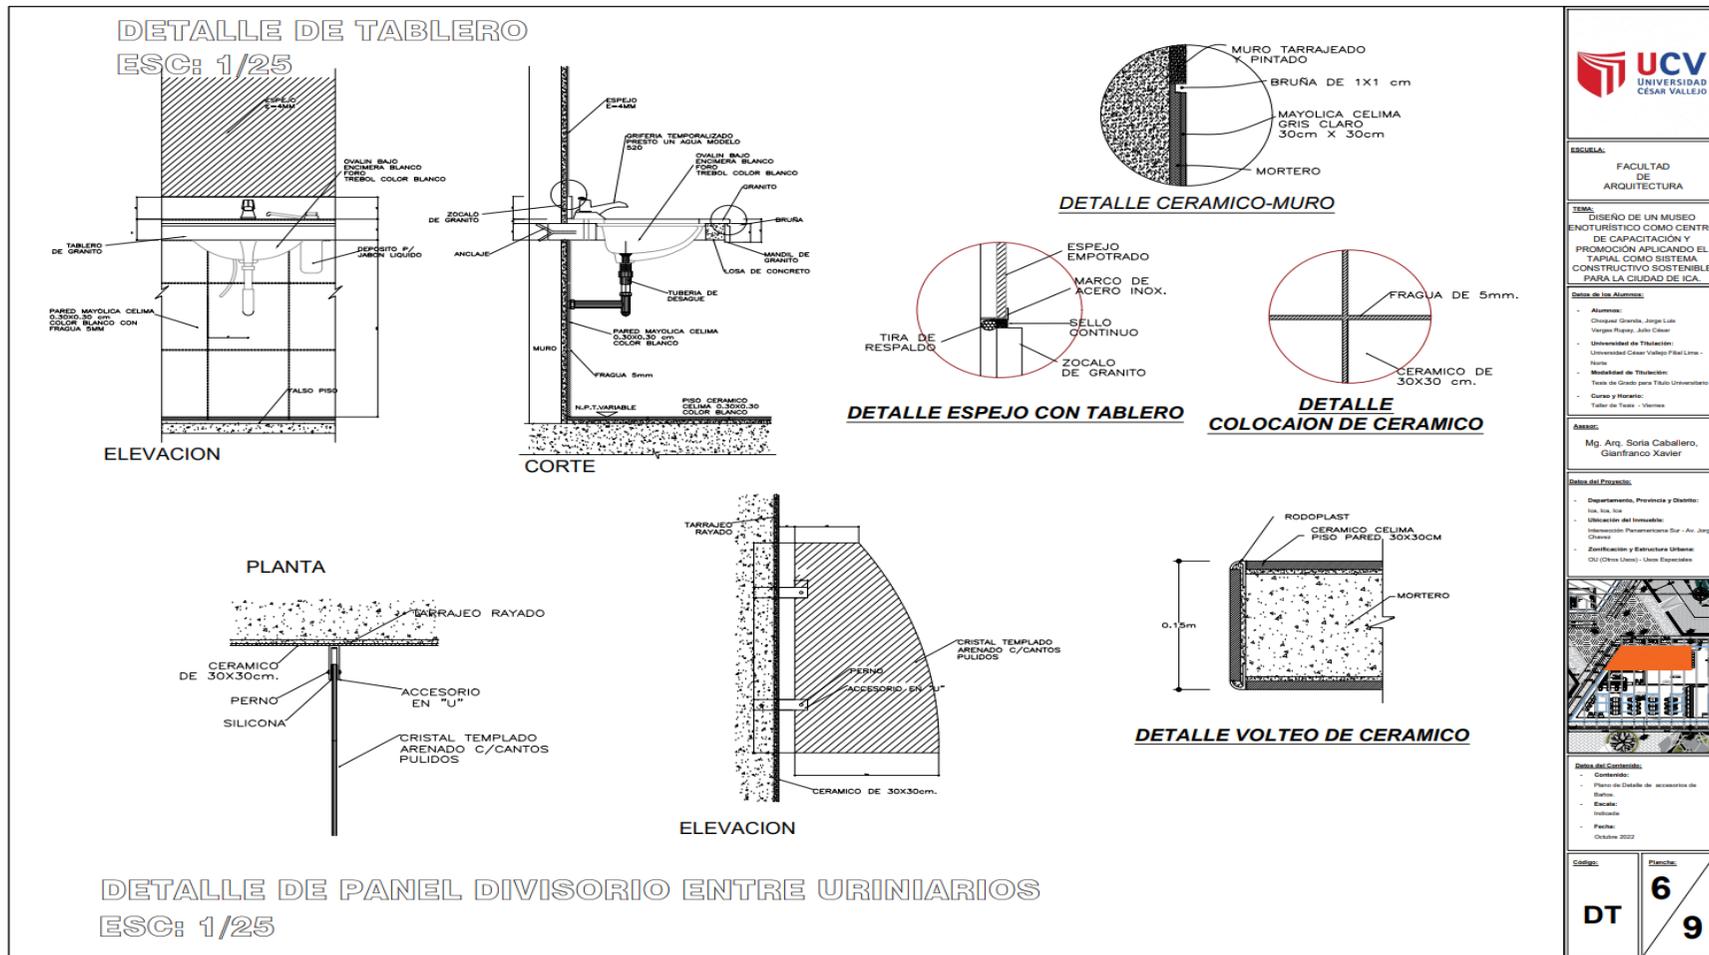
Plano de Detalles Arquitectónicos – Detalles de Baños
